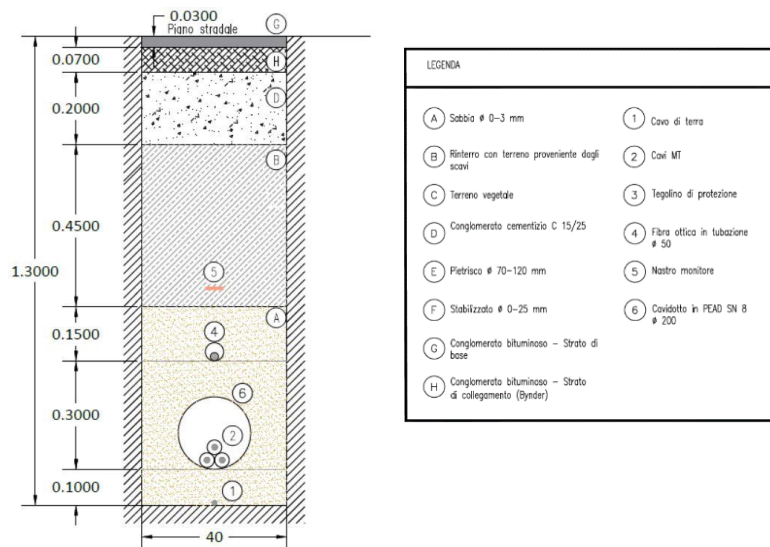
Sezione tipo del cavidotto su viabilità di progetto
